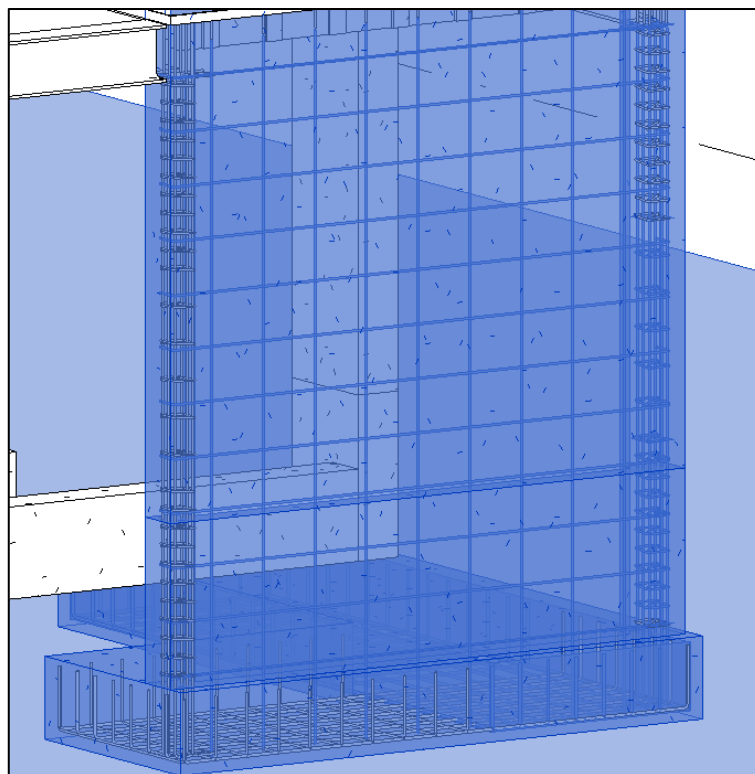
Nivel de detallamiento de los elementos estructurales
